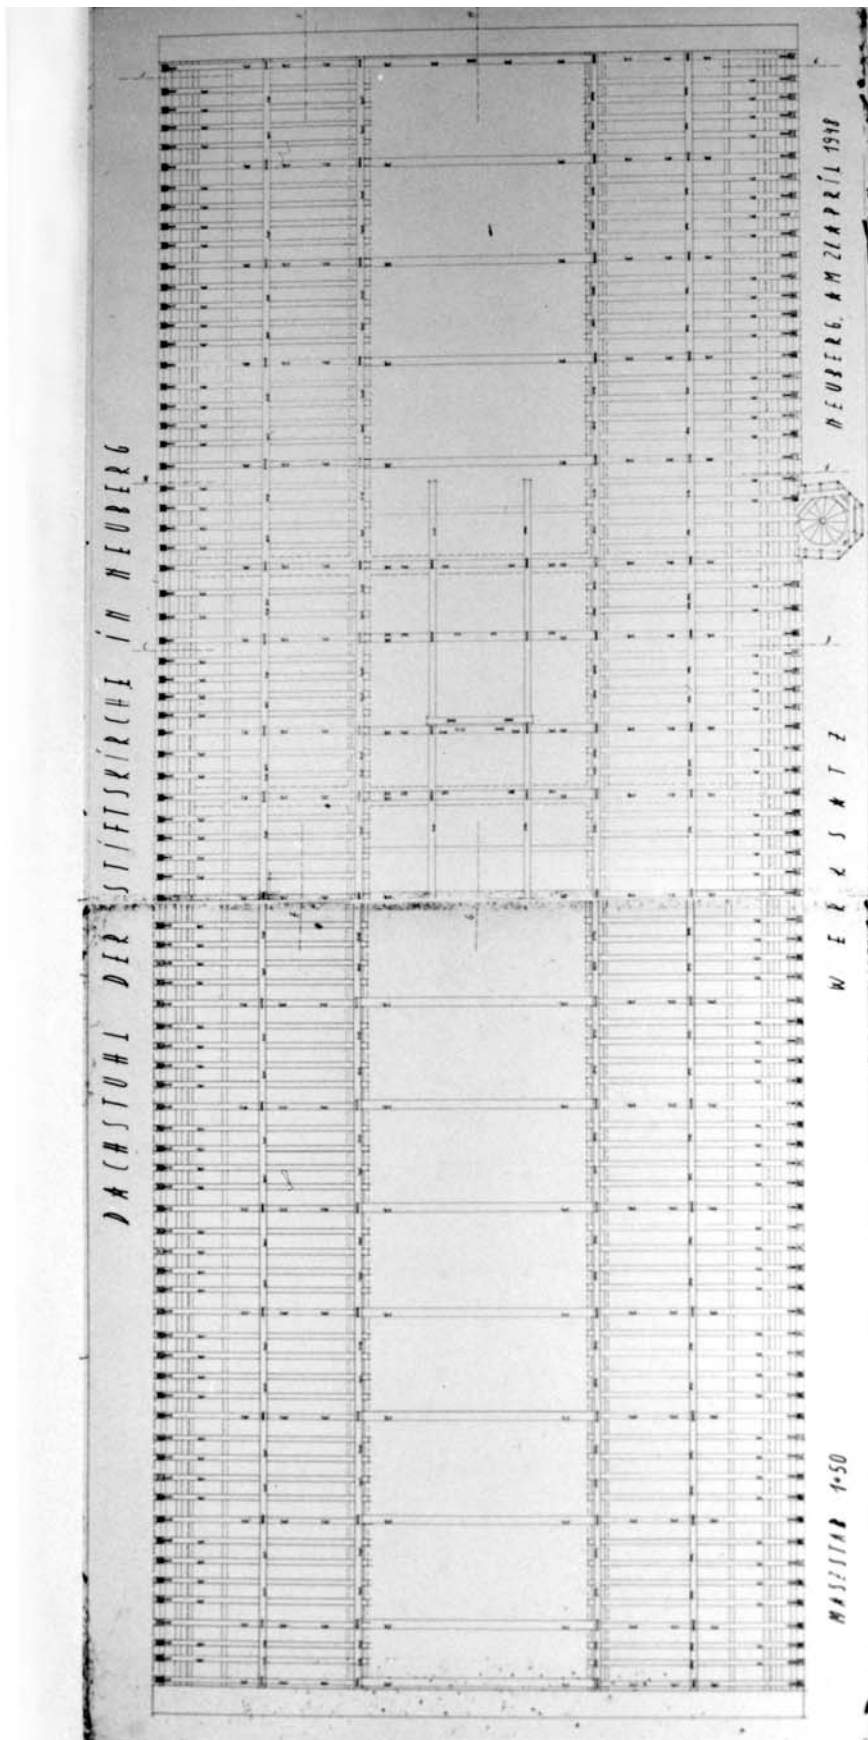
Neuberg, Klosterkirche, Dachstuhl, Grundriß
